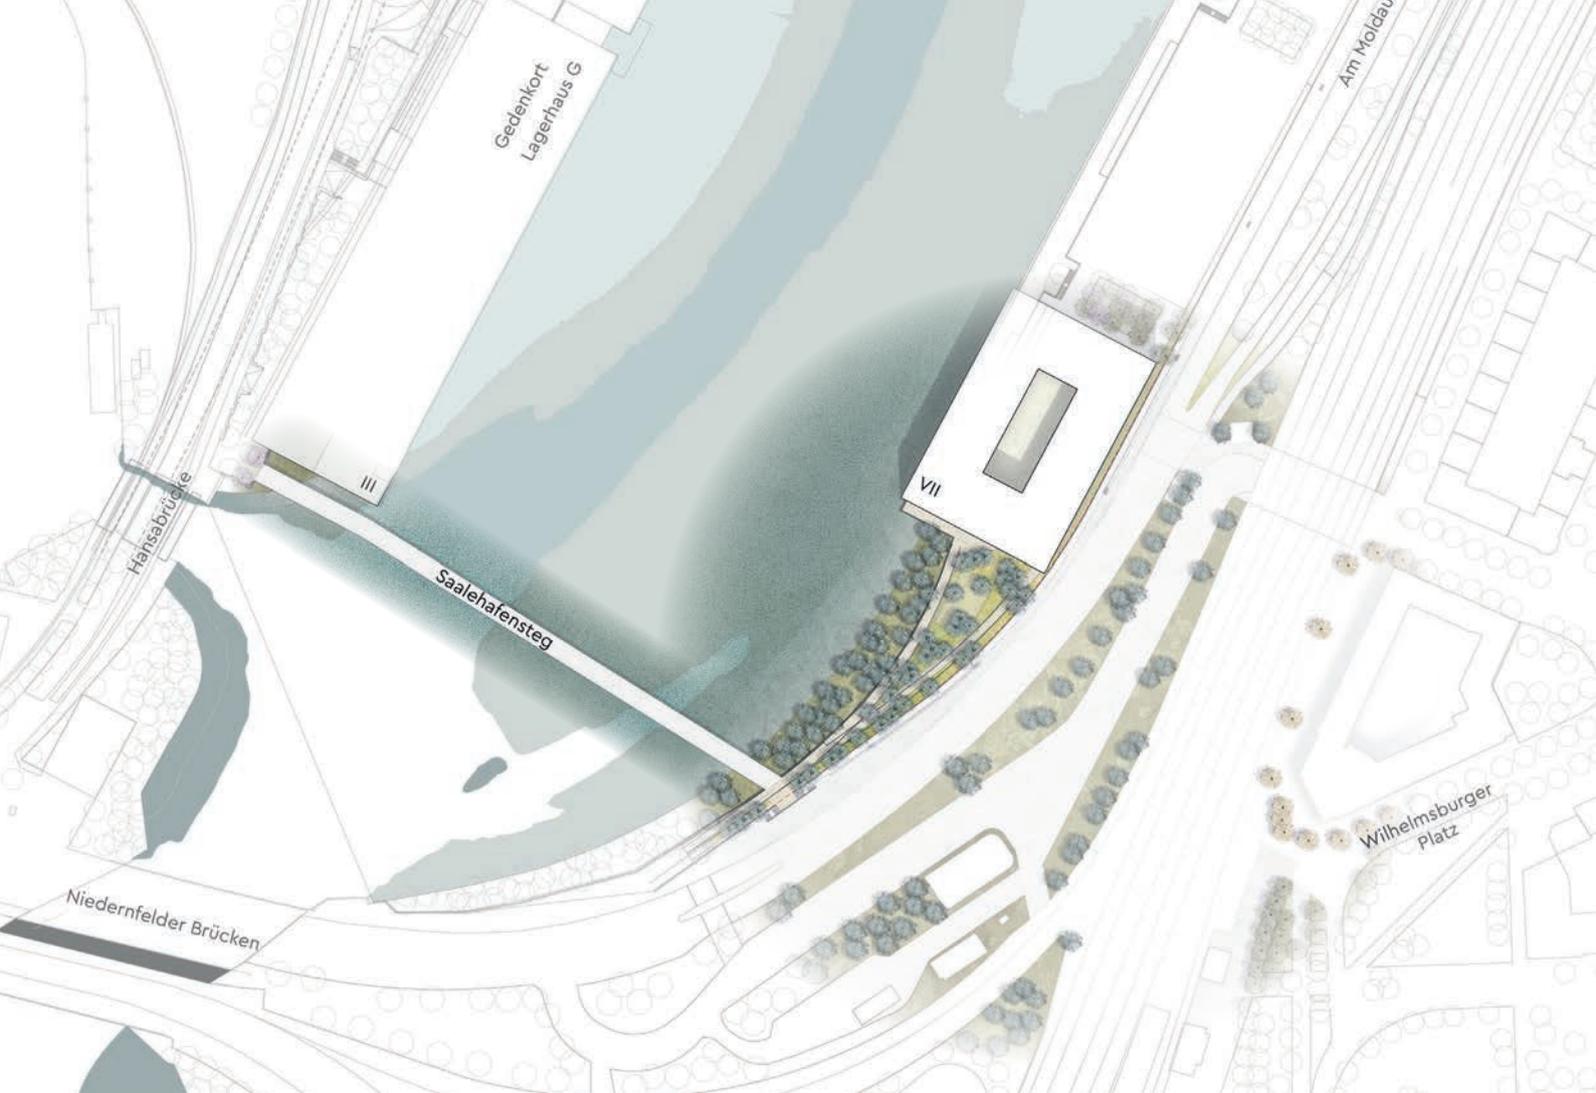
Lageplan Anschlussknoten südliche Veddel und Saalehafensteg
